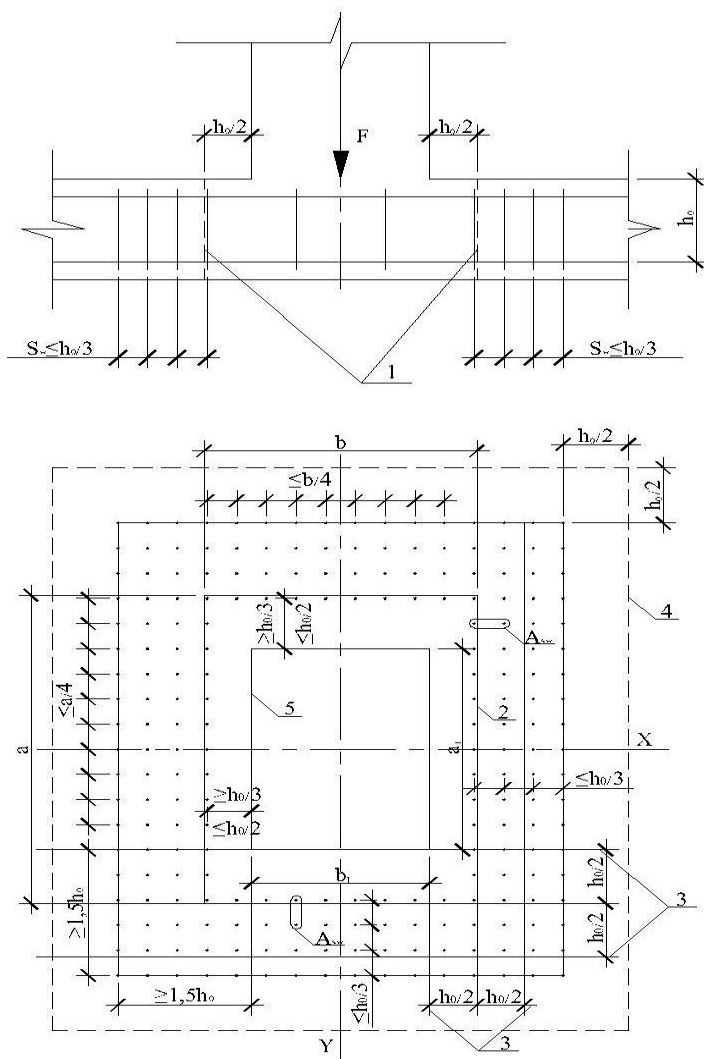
Схема для расчета железобетонной плиты перекрытия с вертикальной равномерно распределенной поперечной арматурой на продавливание:
